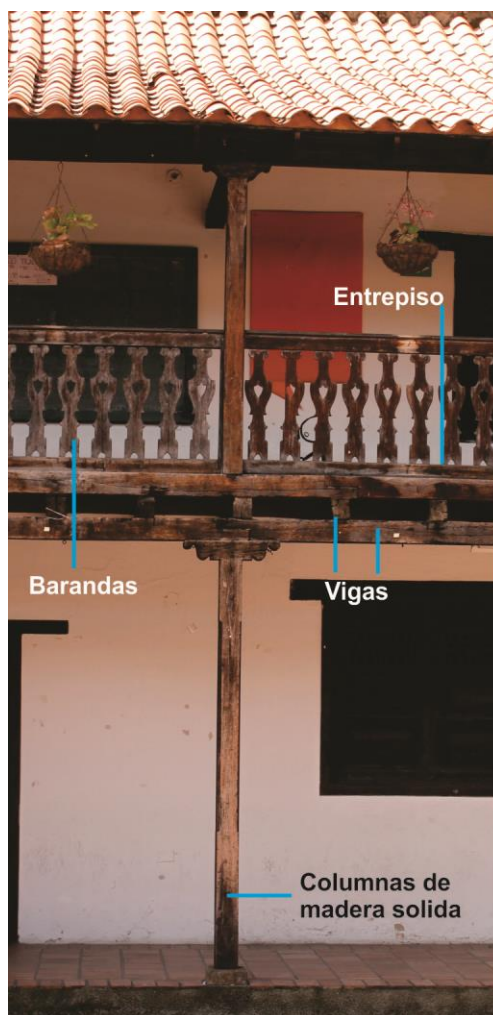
Elementos que componen la balconada de la Casa Valencia.
